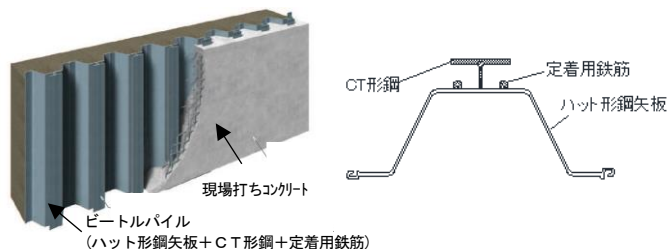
J-WALL II 工法のイメージとビートルパイル断面図
